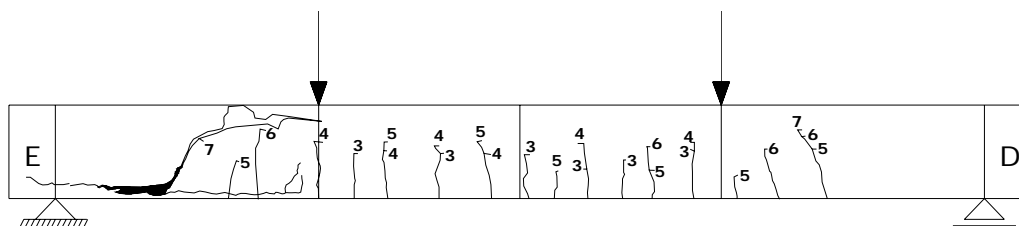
Padrão de fissuração para viga sem armadura transversal
